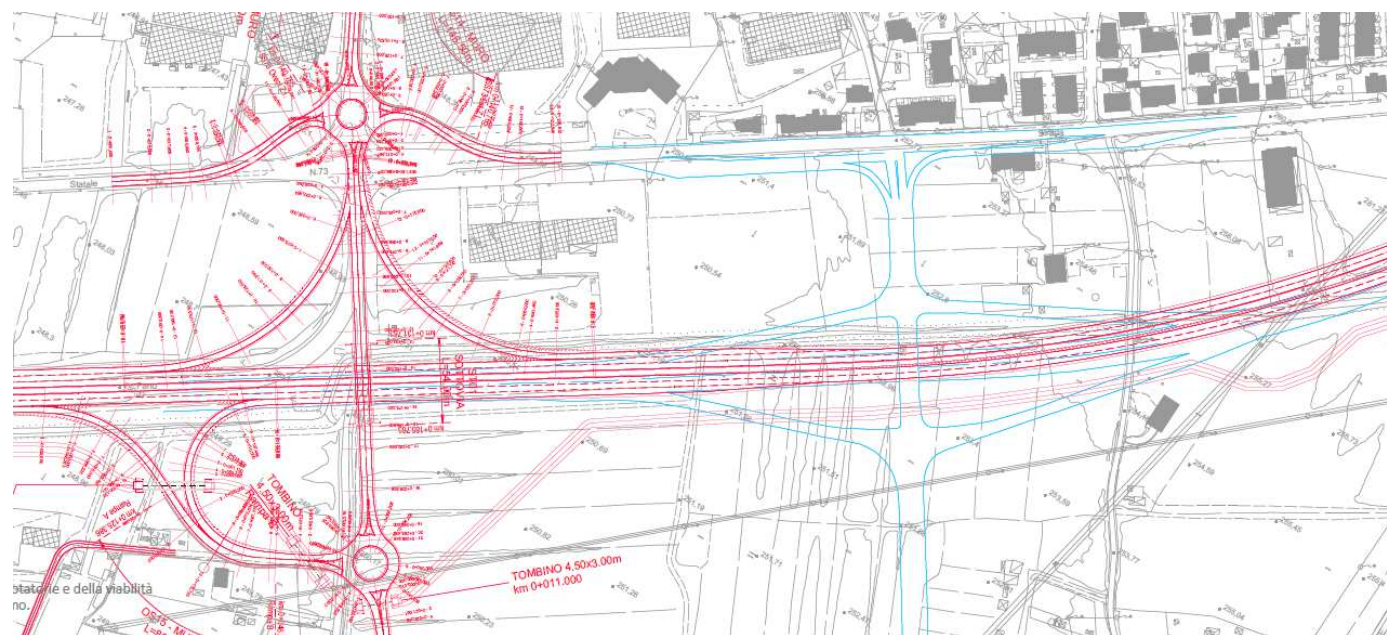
Svincolo “San Zeno” con le aree di cantiere - Estratti elaborato T00AM01AMBPL01 Planimetria di confronto PP e PD 2022
